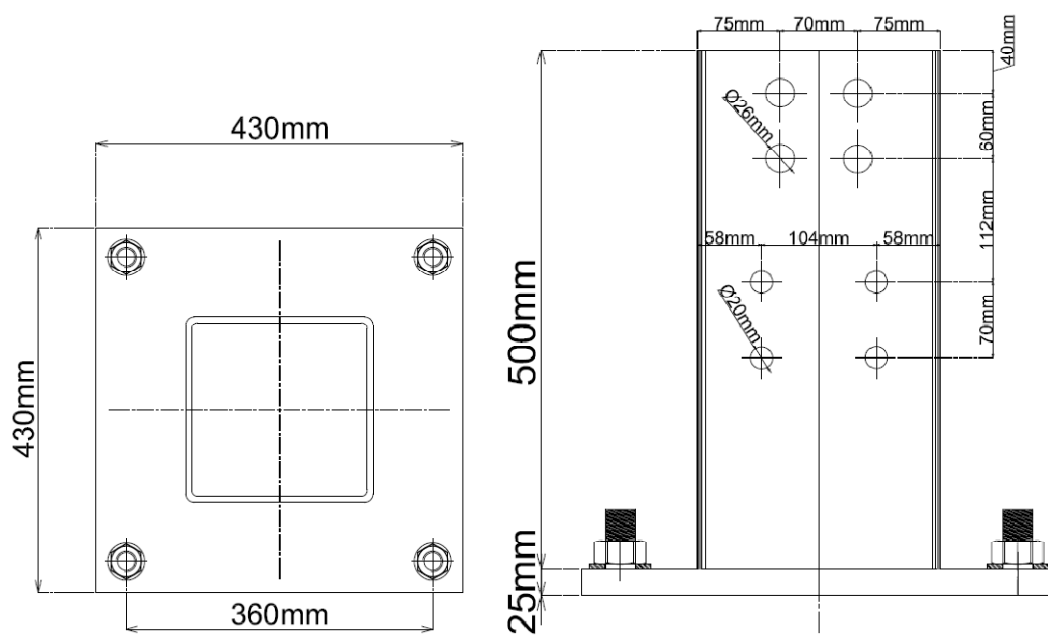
Planta (à esq.) e alçado (à dir.) da base do pilar
